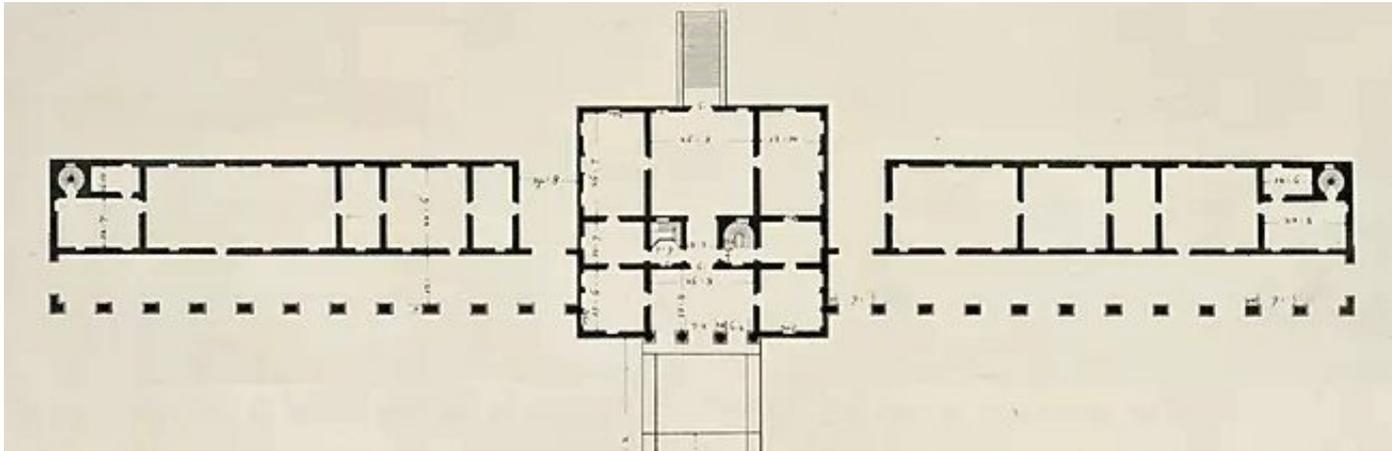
Skizze Grundriss Adaptierung Villa Emo 1796
